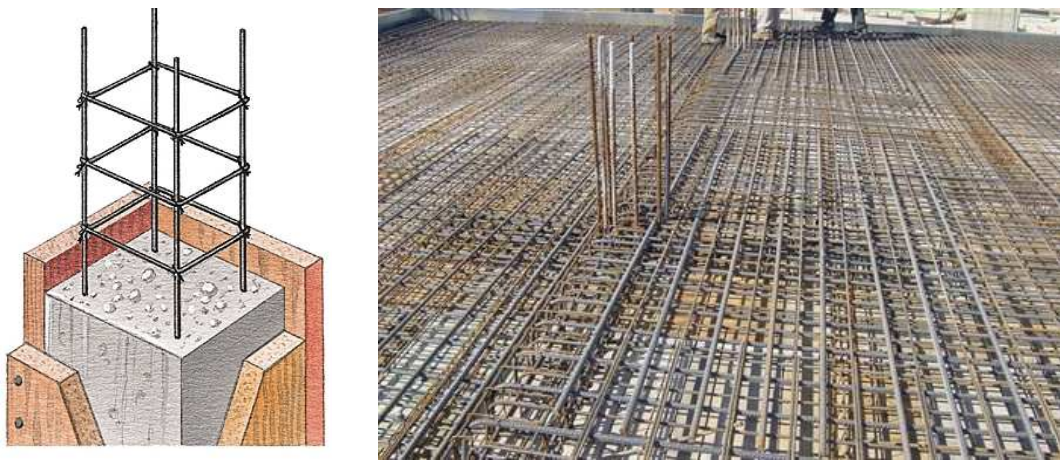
Colonne en béton armé et armature d'acier de la planche
